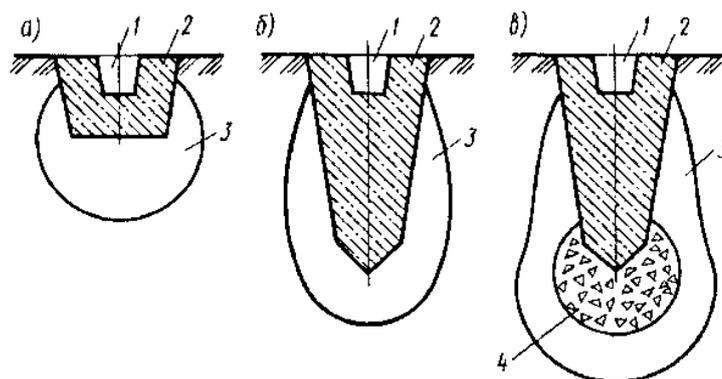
Схемы устройства методом вытрамбовывания котлованов фундаментов с плоской подошвой (а), с заостренной подошвой обычного типа (б) и с уширенным основанием (в): 1 – стакан для установки колонны; 2 – фундамент; 3 – зона уплотнения; 4 – утрамбованный жесткий грунтовой материал
